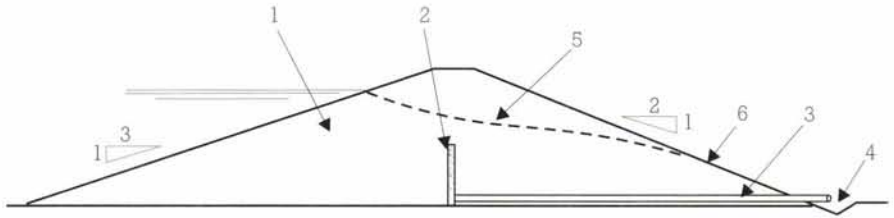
Profil type du barrage de TOURAN (Lot-et-Garonne).
